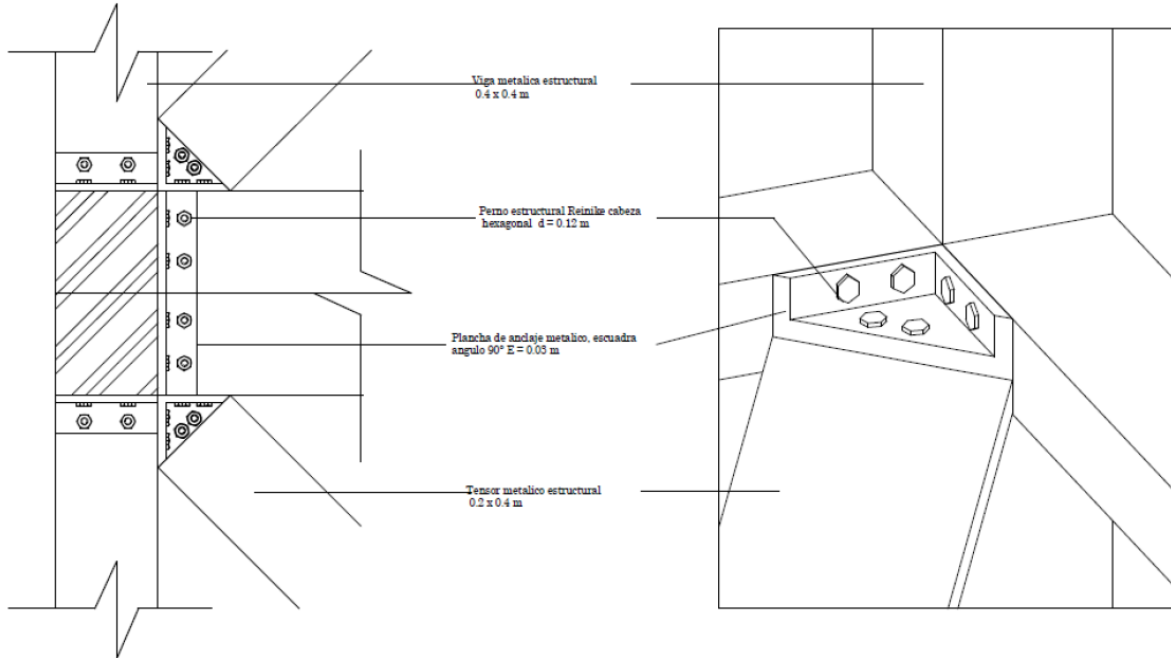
Detalle de unión, Fuente: Elaboración Propia
